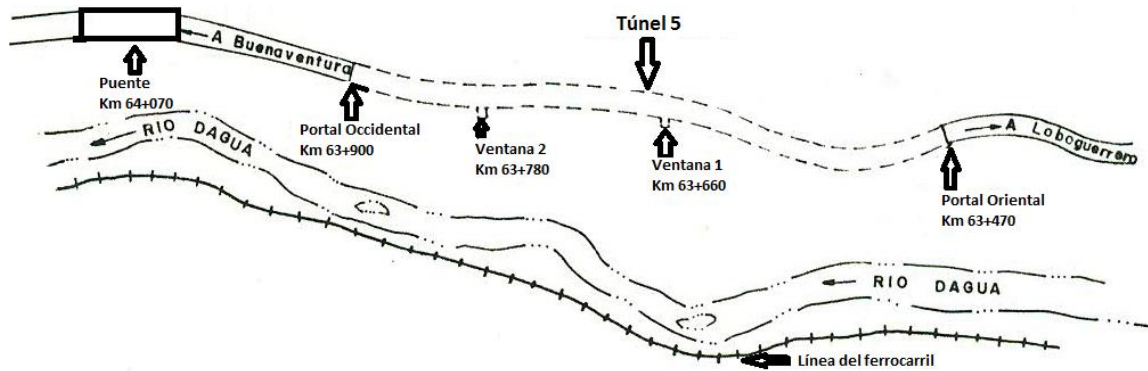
Detalle del área de los levantamientos, en zona del Túnel 5
